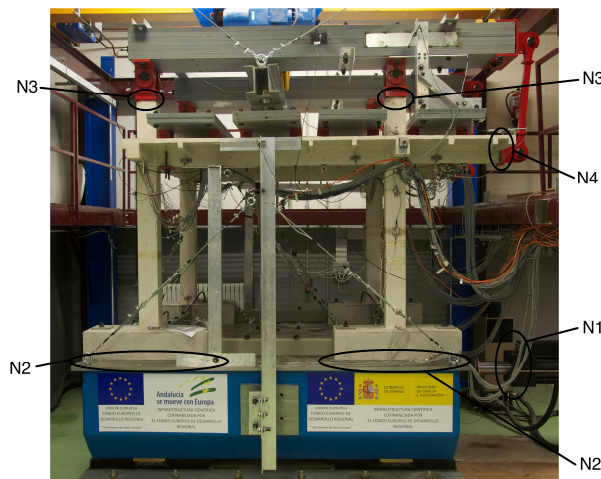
Ubicación de las previsible fuentes ruidosas ajenas a la fisuración del hormigón.
